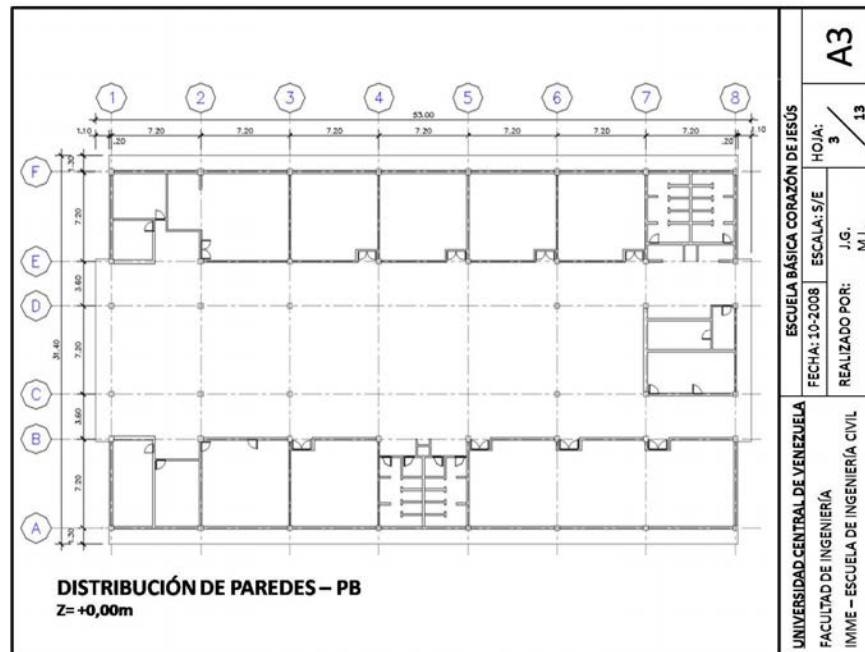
Distribución de paredes de mampostería en la planta baja.
